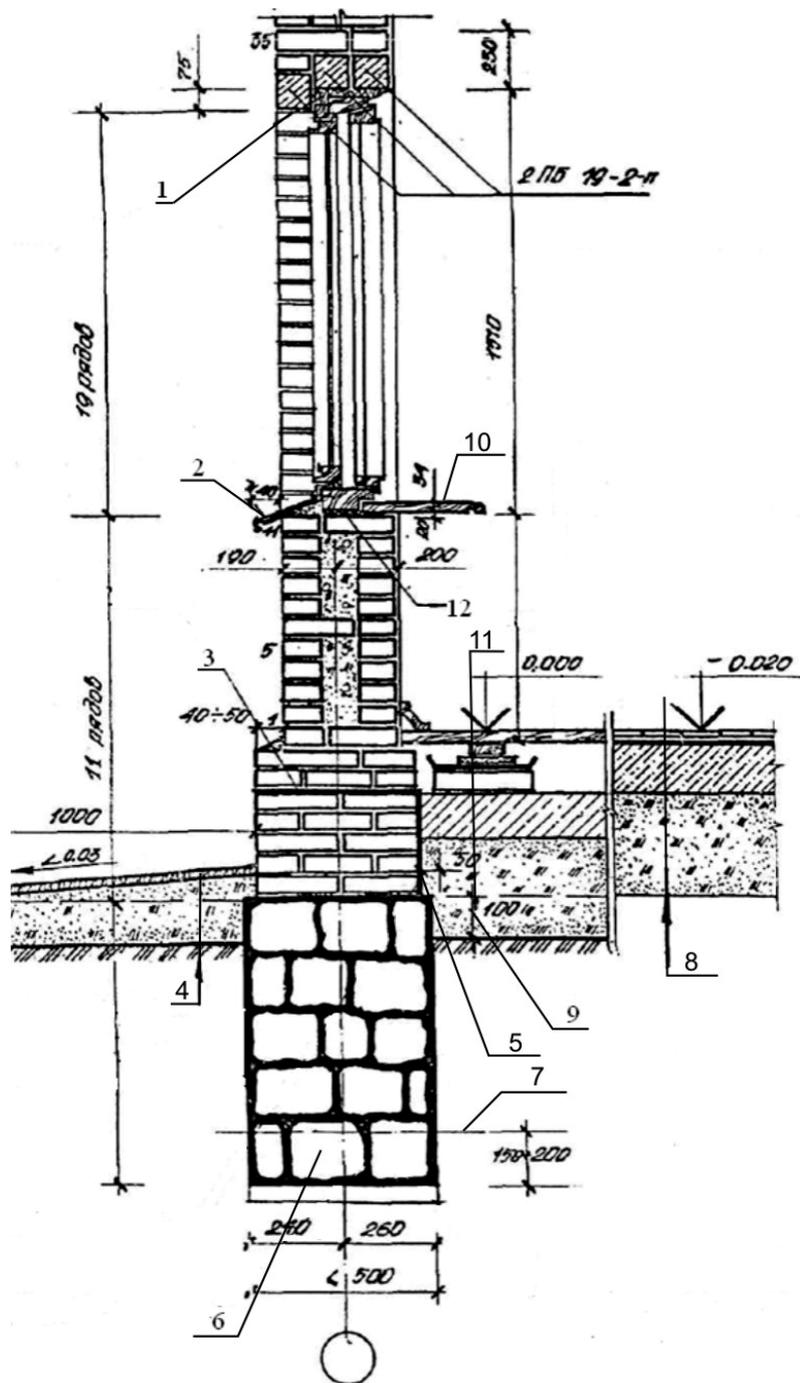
Порядовка наружной стены эффективной кирпично-бетонной кладки: 1 — конопатка; 2 — слив из оцинкованной кровельной стали; 3 — гидроизоляция 2 слоя толя; 4 — асфальт — 30 мм, щебень 100...150 мм, песчаная подстилка; 5 — вертикальная гидроизоляция горячим битумом за 2 раза; 6 — фундамент бутовый раствор М50; 7 — линия глубины промерзания грунта; 8 — керамические плитки, стяжки цементно-песчаным раствором М100, гидроизоляция, бетонная подготовка М 100-80, уплотненный щебнем грунт; 9 — срезка растительного слоя; 10 — деревянная подоконная доска с осмоленным низом, уложенная на слой антисептированного войлока, смоченного в гипсовом растворе; 11 — шпунтовые доски, лаги из досок; 12 — подкладка толщиной 25 мм, 2 слоя толя, кирпичный столбик, мм, гравий или щебень — 80 мм, утрамбованный грунт
